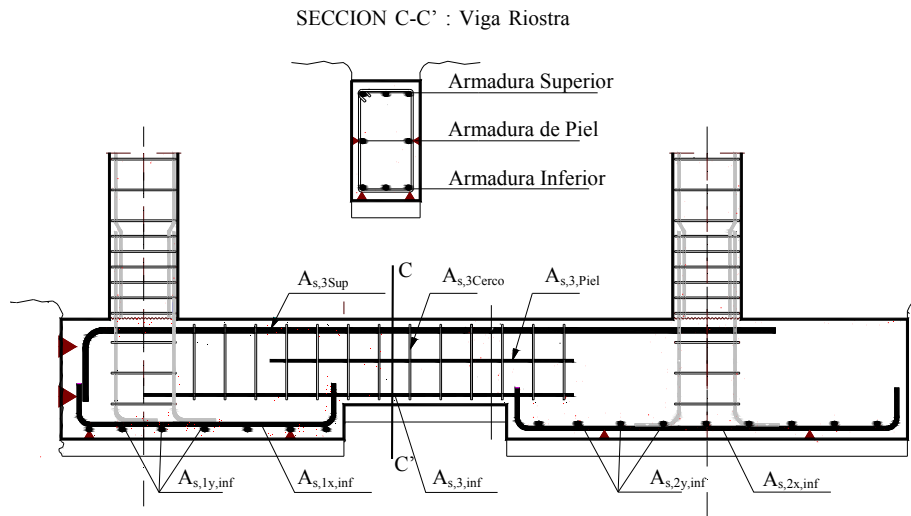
Modelo 2. Zapata excéntrica con viga centradora. Patrón Armado
